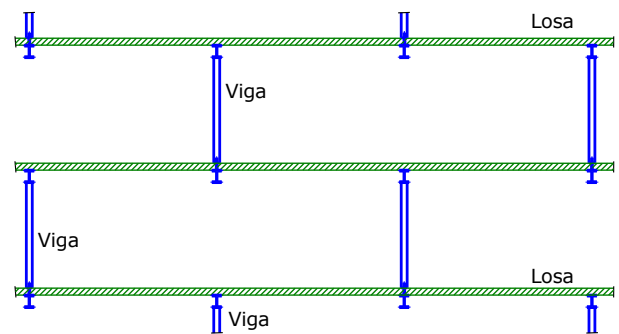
Corte del edificio en la dirección perpendicular a las vigas reticuladas.
